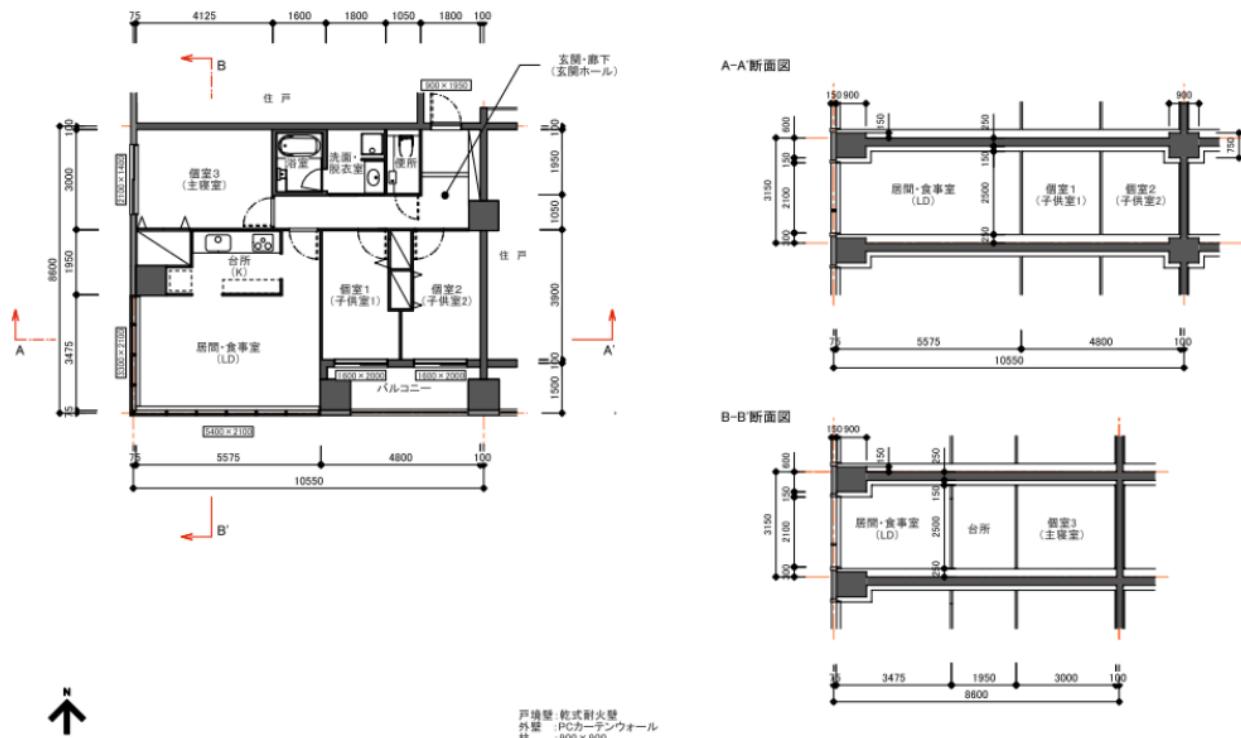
3LDKタワー型モデルの平面図・断面図
